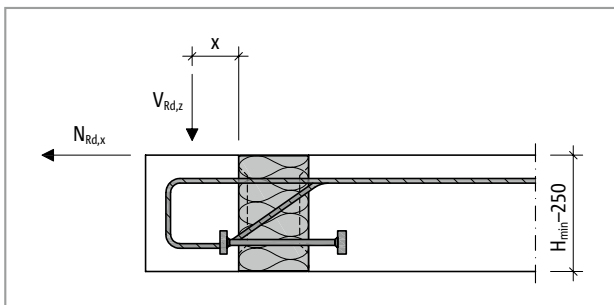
Schöck Isokorb® XT Typ O: Abstand des Lasteinleitungspunktes x (Lastabstand)
